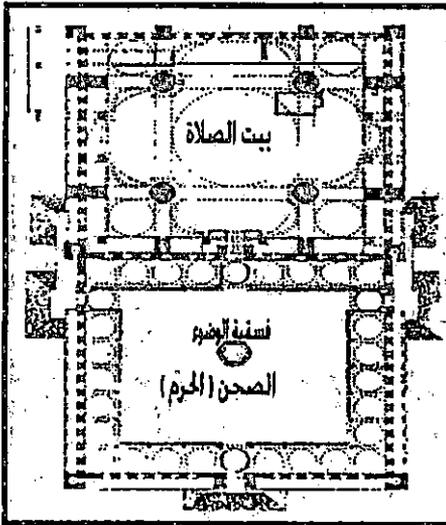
مسقط أفقي خان الأرا على
